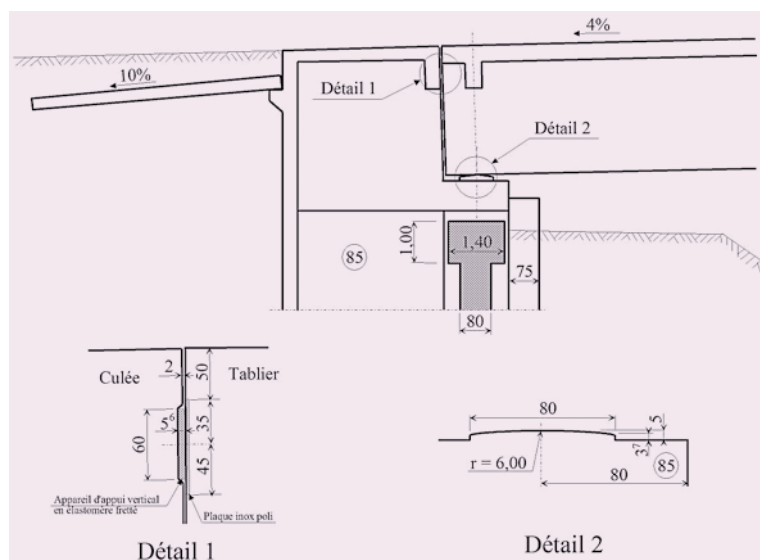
coupe longitudinale : culée boîte – Source : Setra
